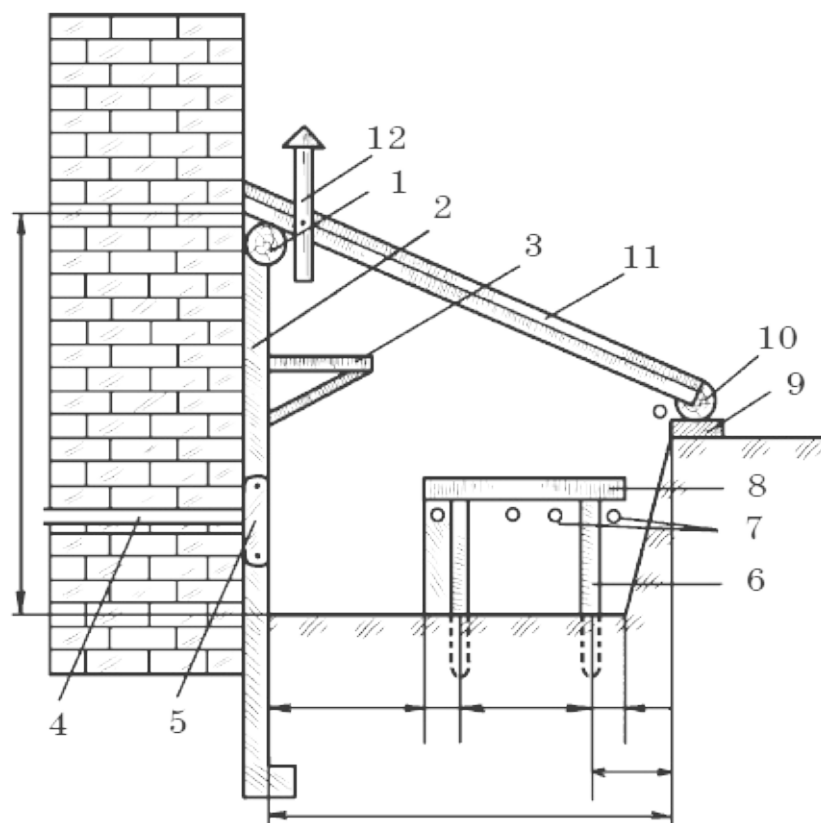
Пристенная теплица: 1 и 10 — верхний и нижний лежни; 2 — столбы; 3 — полка; 4 и 7 — трубы водопровода и отопления; 5 — радиатор отопления; 6 — стойка стеллажа; 8 — стеллаж; 9 — основание; 11 — застекленный скат; 12 — вентиляционная труба
